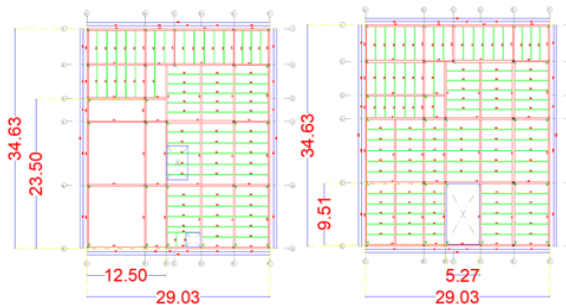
Configuración en planta de la estructura en planta baja y alta
